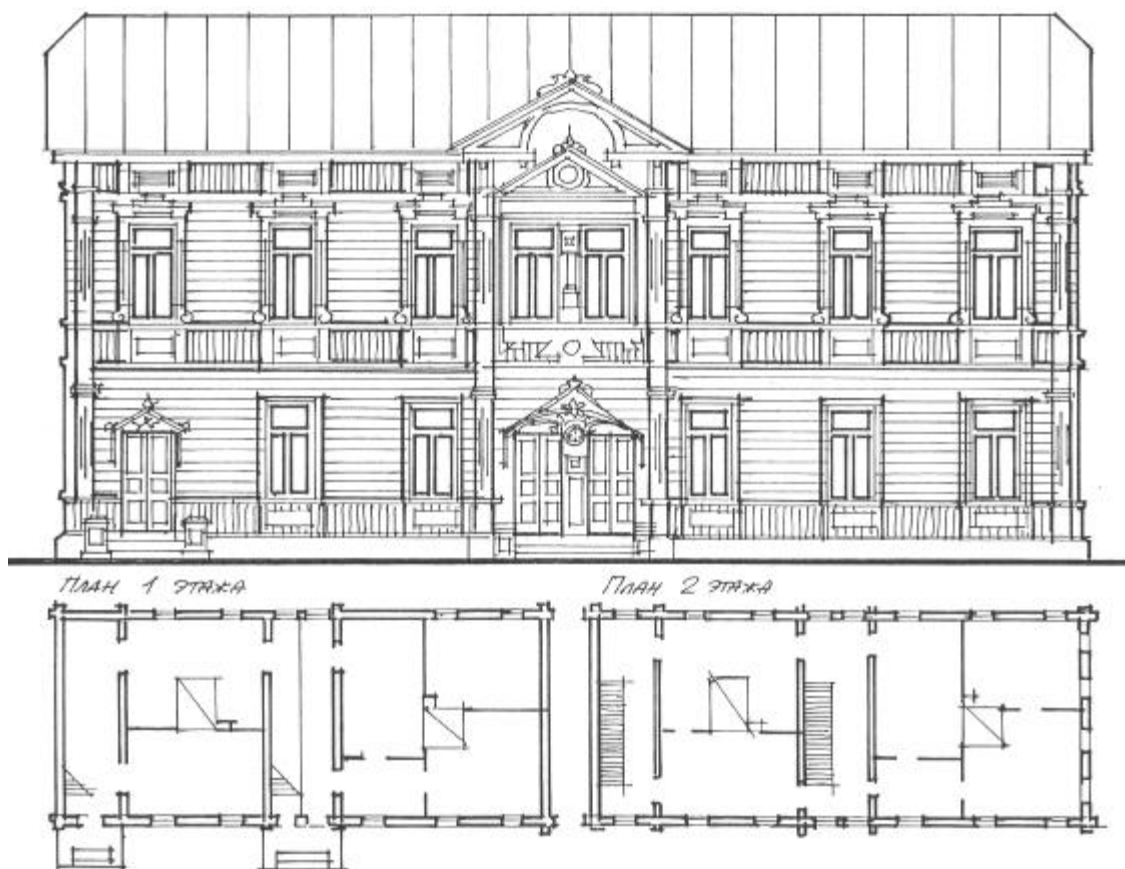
Фасад и планы дома Ситдика Мусина. Проект 1902 года
